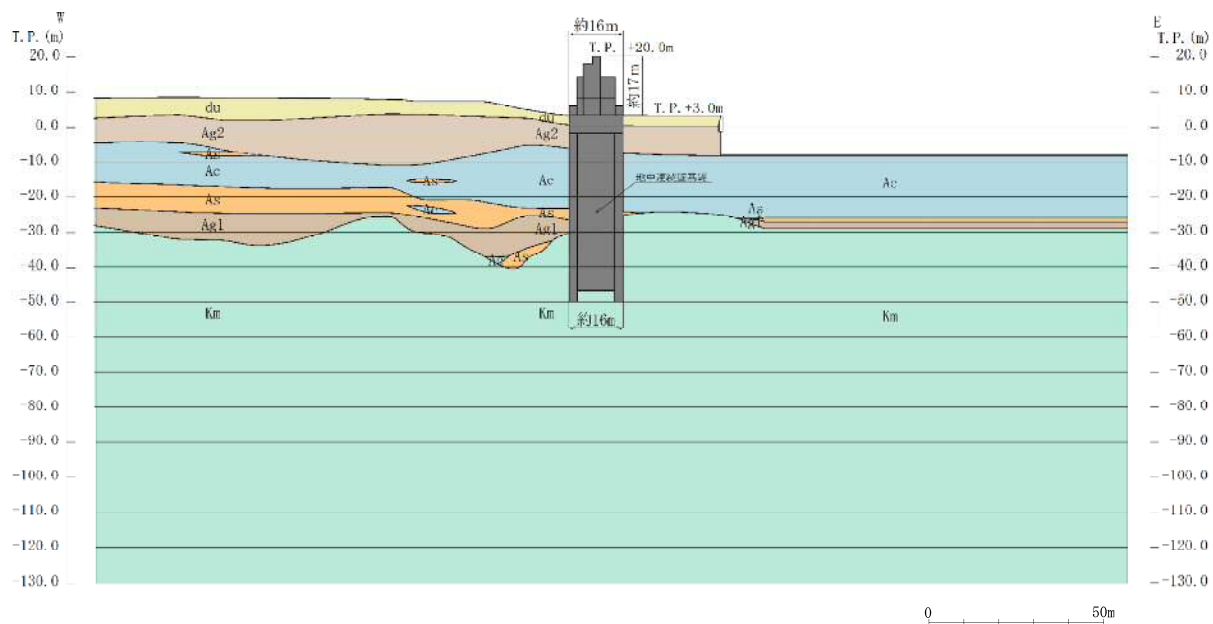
(3) 鋼製防護壁断面図 (③-③断面)
